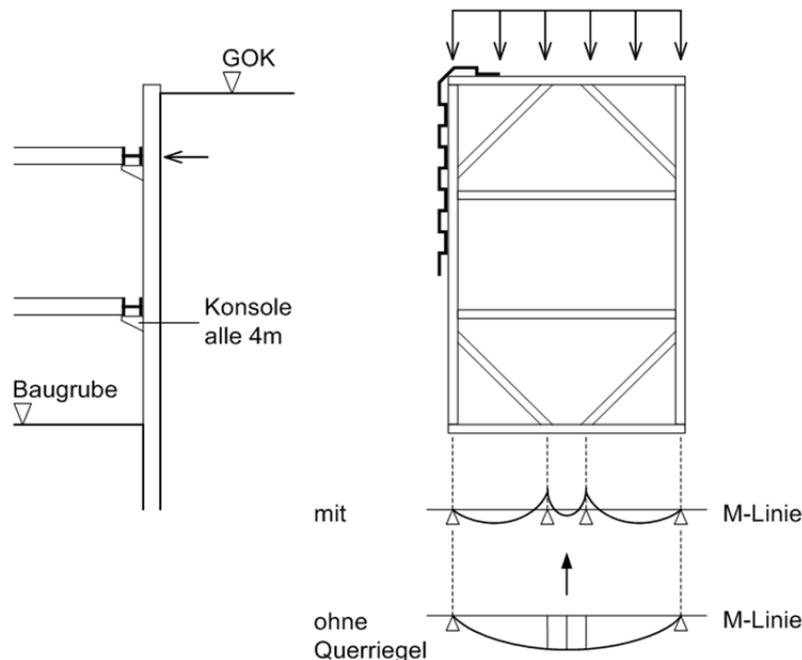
Baugrubenaussteifung: horizontaler Rahmen
